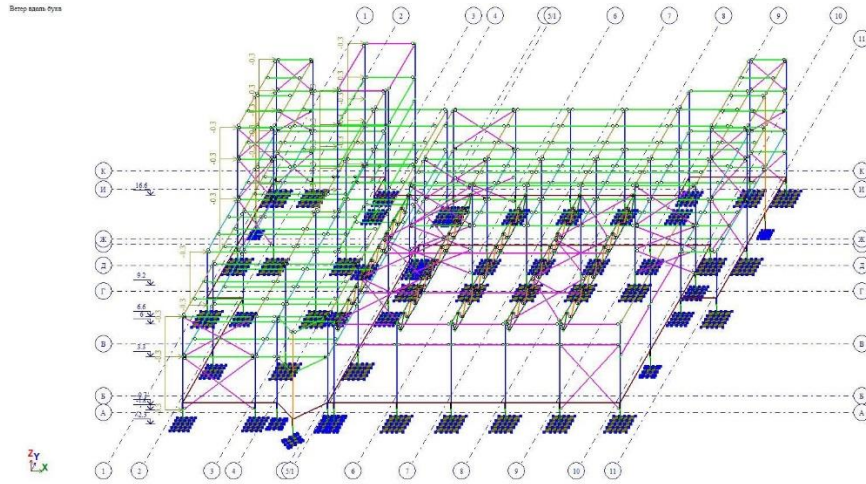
Нагрузки. 6 – Ветер вдоль буквенных осей
